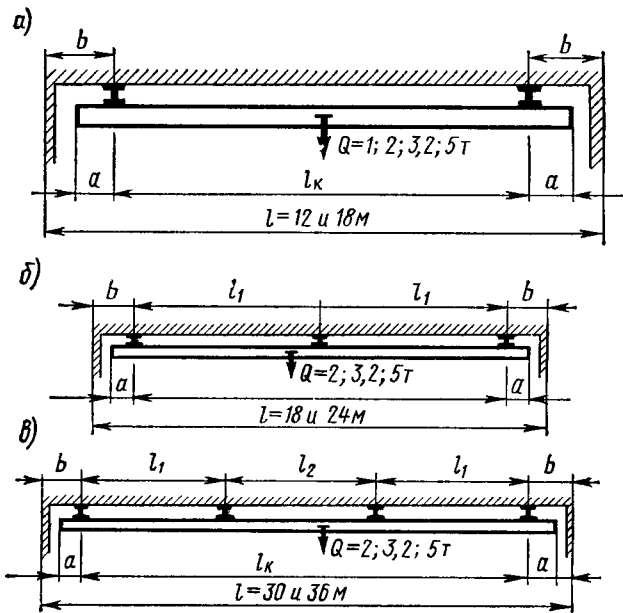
Схема расположения одного подвесного крана для пролетов:
